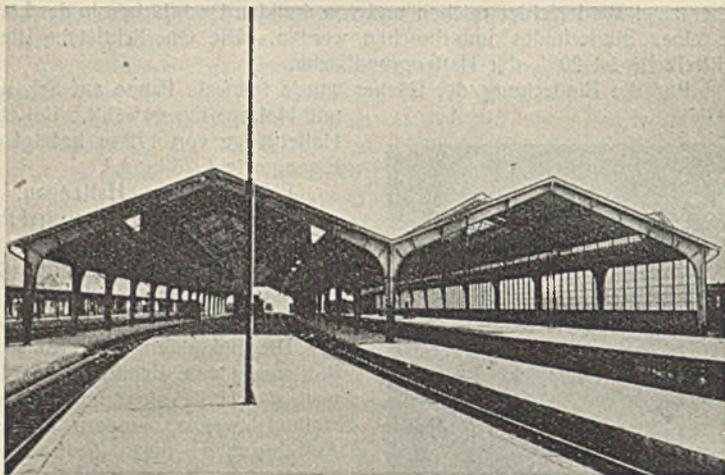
Bahnsteighallen zu Frankfurt a. O.
